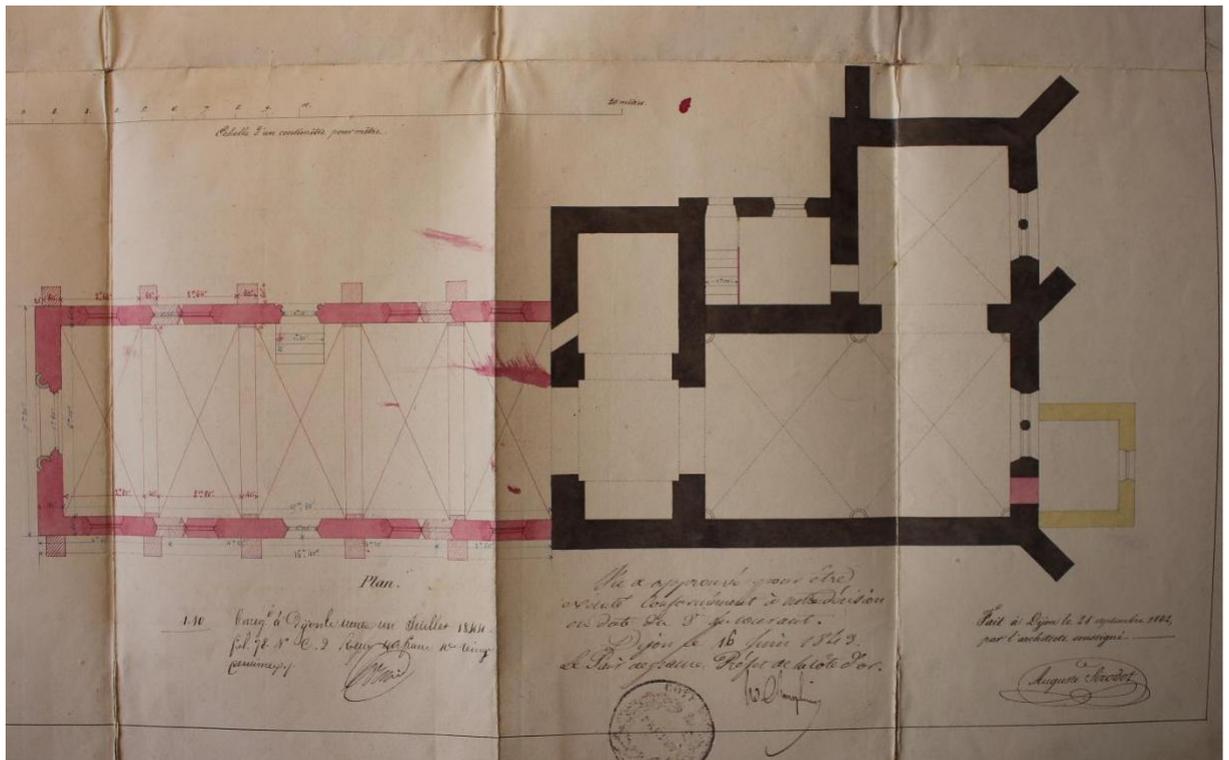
Plan de reconstruction de la nef et mentions et signature d'Auguste Sirodot
